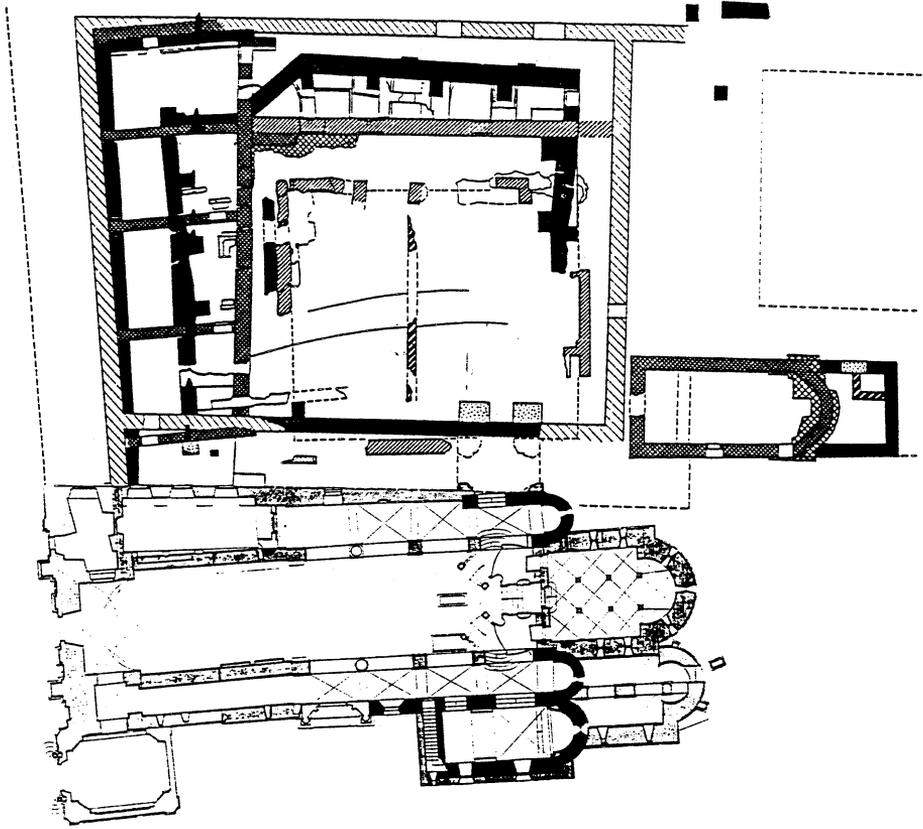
Die St. Georgsbasilika auf der Prager Burg mit der Klausur, in deren Grundriss die archäologischen Funde der Überreste mittelalterlicher Bauten gekennzeichnet sind.
